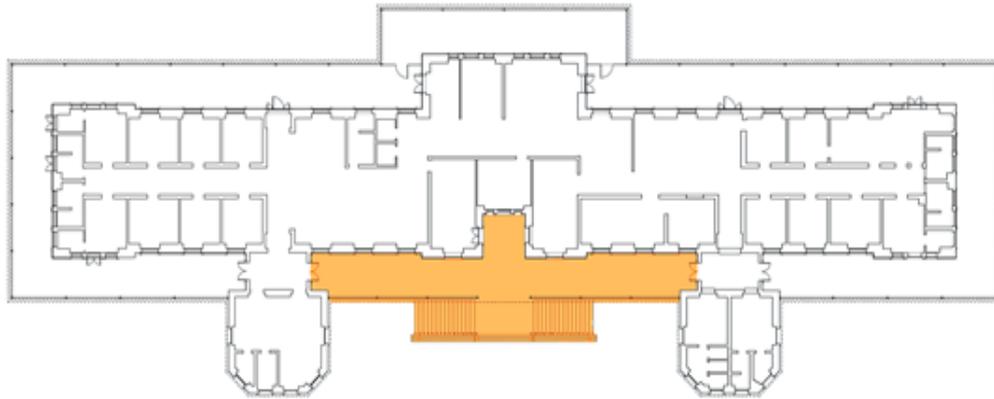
Planta baixa do Hospital Evandro Chagas – 1º pavimento - indicação da área analisada (desenho da autora)
